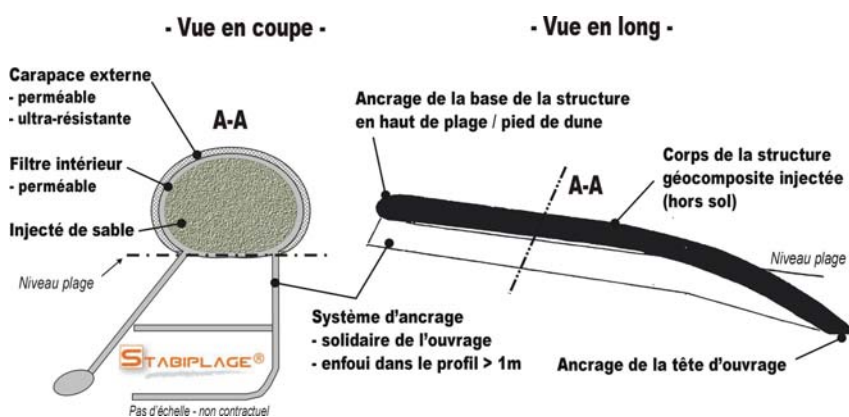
Coupe transversale et longitudinale d'un Stabiplage® avec ancrage (source : Espace Pur)
